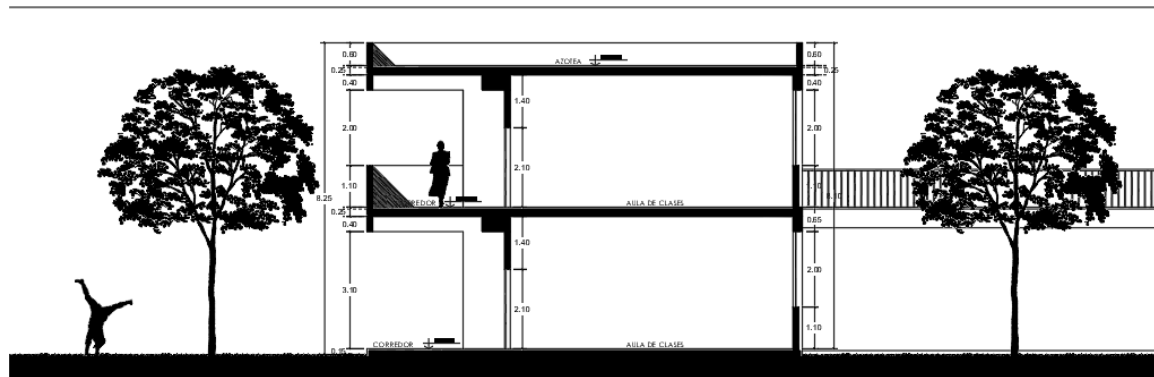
Corte de Aulas y patio central - Fuente: Propia
